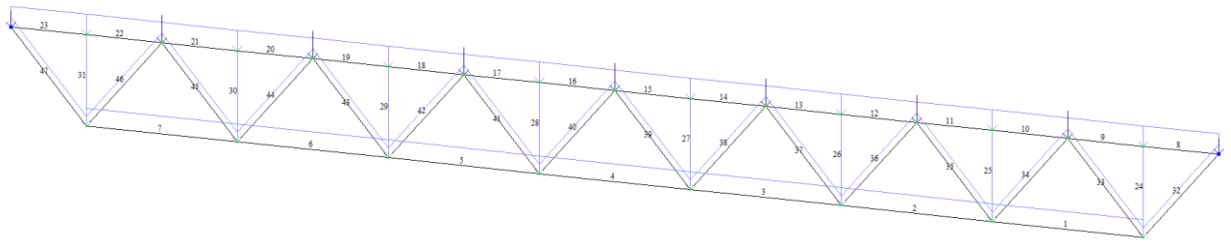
Загрузка фермы собственным весом и нагрузкой от покрытия
